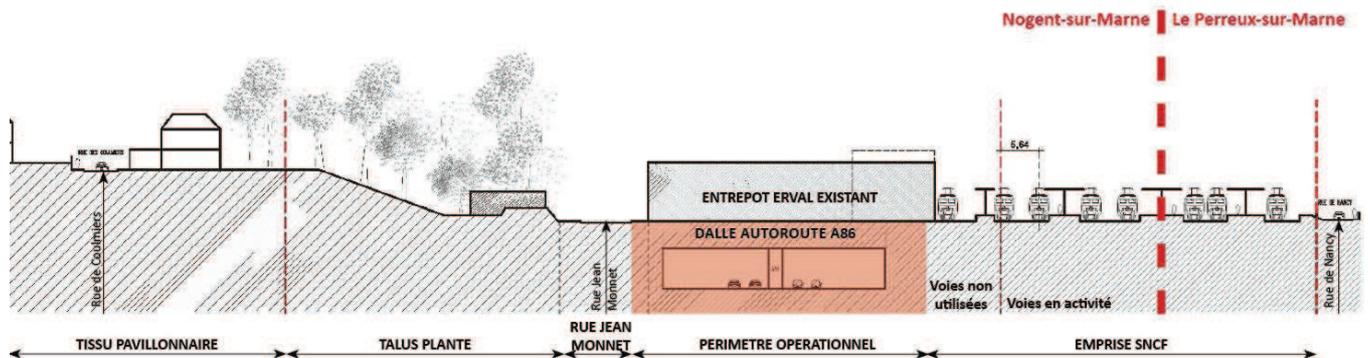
Coupe générale de principe, issue du plan schématique transmis par la ville, SPL
